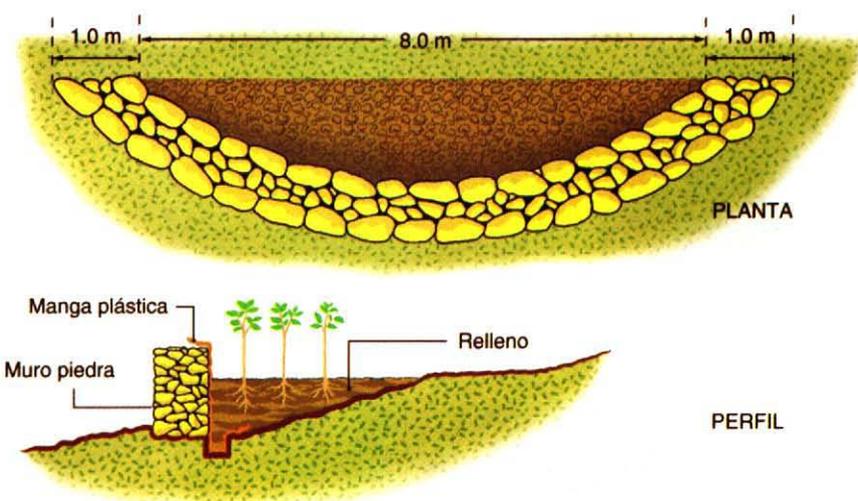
Plano de una terraza con muro de piedra de 8 m largo.
